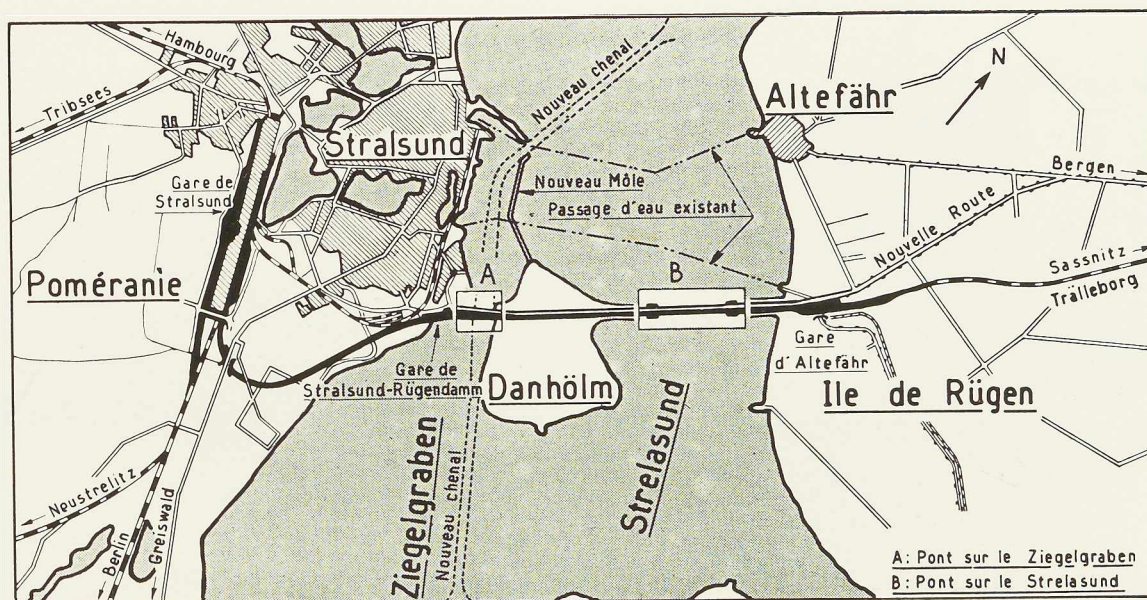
Plan de situation des ponts entre la Poméranie et l'île de Rügen.
